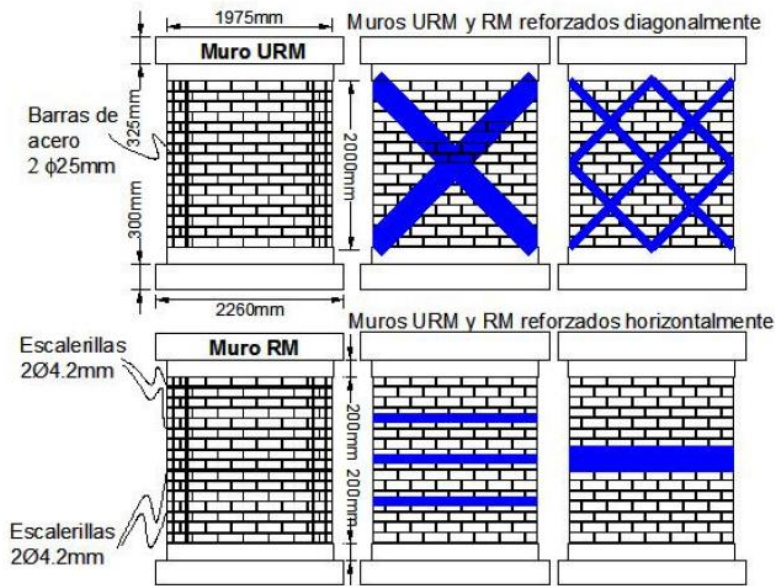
Posibilidades de reforzamiento en un muro con láminas de FCRP. Fuente: ALCAINO, P. y SANTA MARÍA, H. *Resistencia al corte de muros de albañilería reforzados exteriormente con fibras*. Santiago de Chile: s.n., 2008. XXXIII Jornadas sudamericanas de Ingeniería Estructural.
